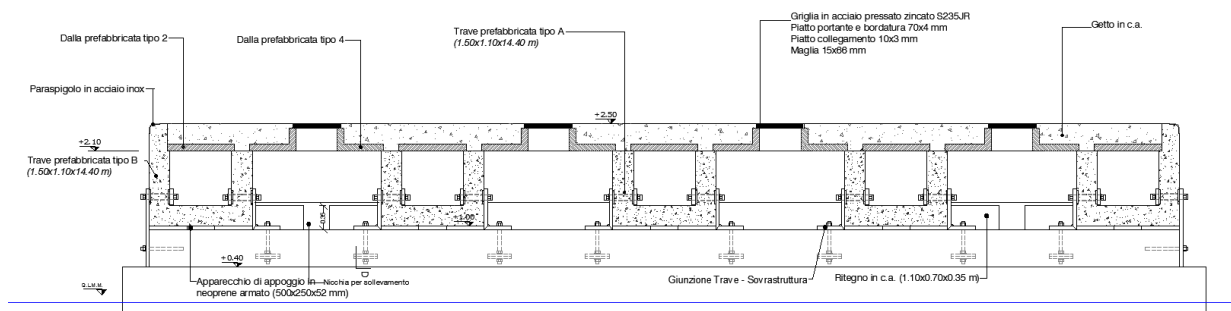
Sezione trasversale dell'impalcato del Pontile 3
